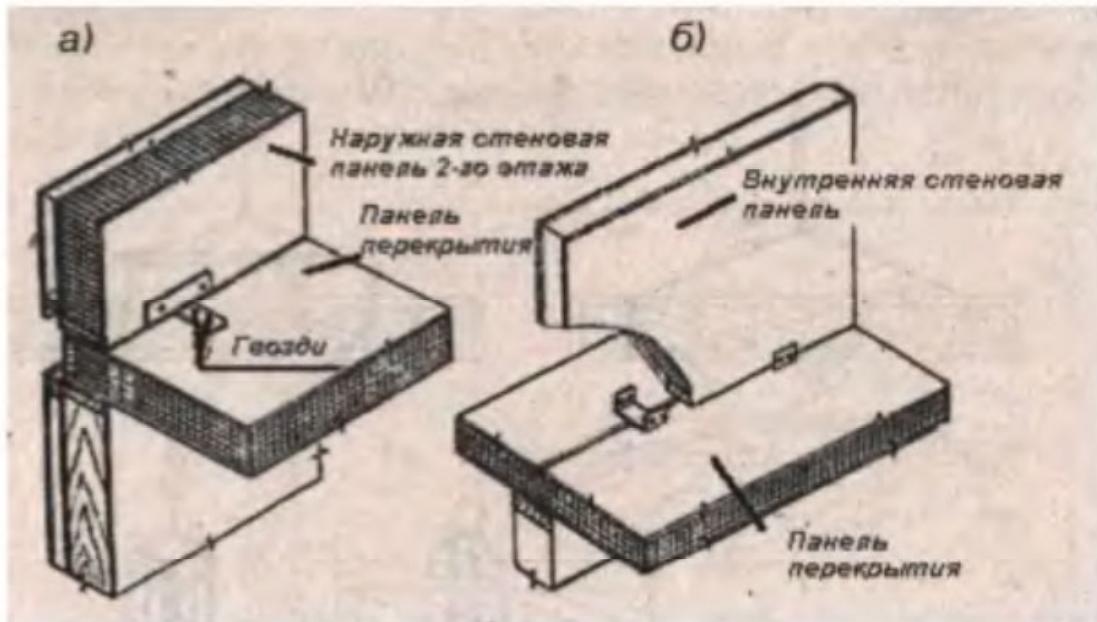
Узлы опирания и крепления панелей: а - наружных стеновых панелей, устанавливаемых по осям; б - внутренних стеновых панелей
